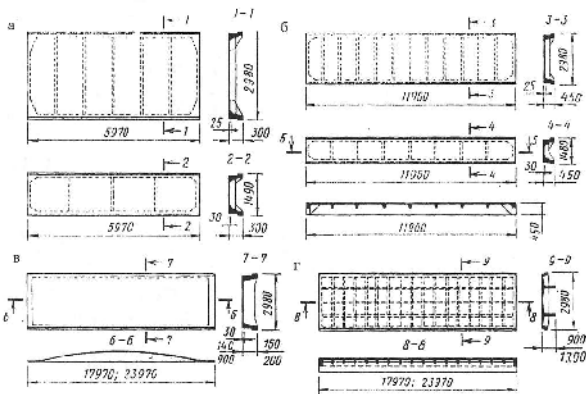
Крупноразмерные железобетонные плиты покрытий: а – предварительно напряженные размером 3×6 и 1,5×6 м; б – то же, размером 3×12 м; в – армцементные двойной кривизны; г – типа 2Т
